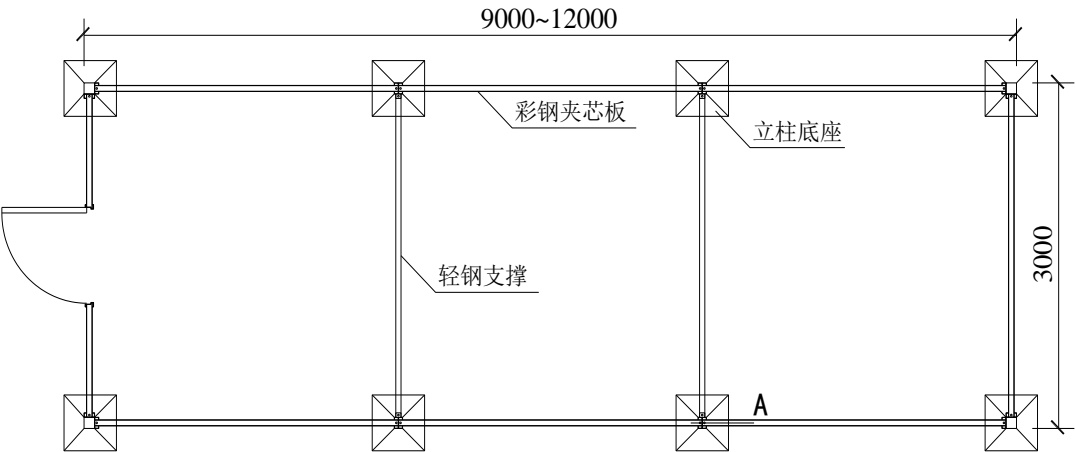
装配式活动厢围蔽平面尺寸示意图（单位：mm）
